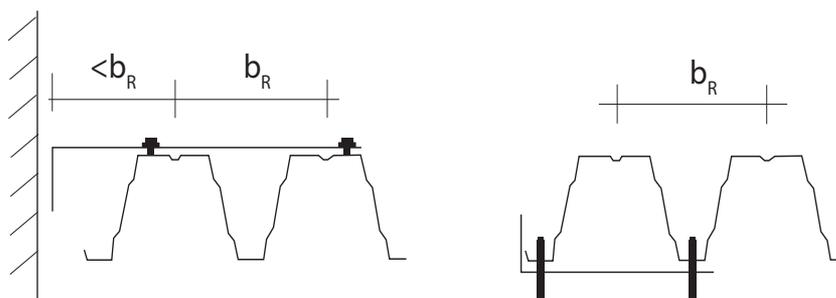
Assemblage sur semelle supérieure ou inférieure d'un bac
